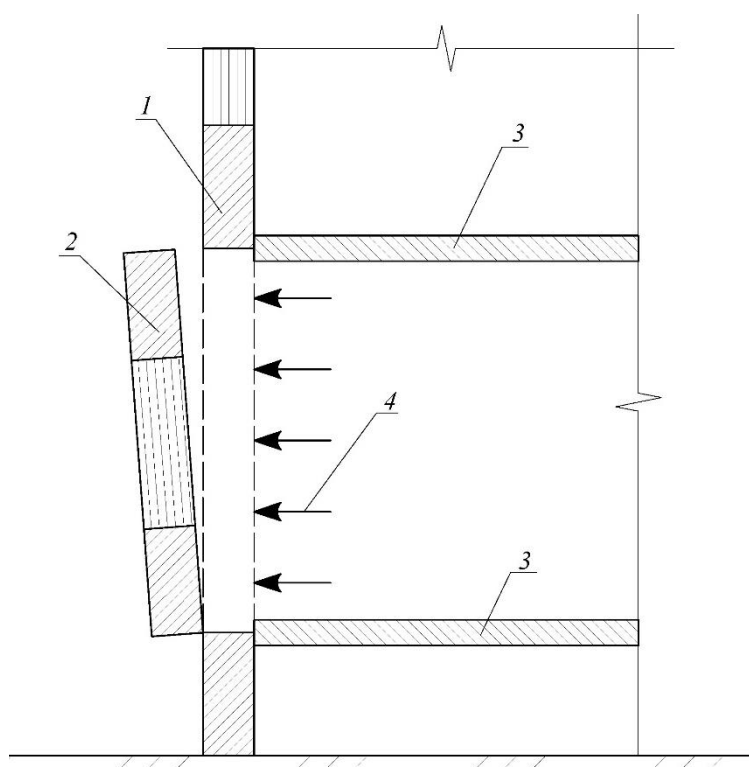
Принципиальная схема дефекта – смещение панели из плоскости стены: 1 – нормальное положение стеновой панели; 2 – смещение панели из плоскости стены (показано условно); 3 – перекрытие, 4 – направление смещения.
